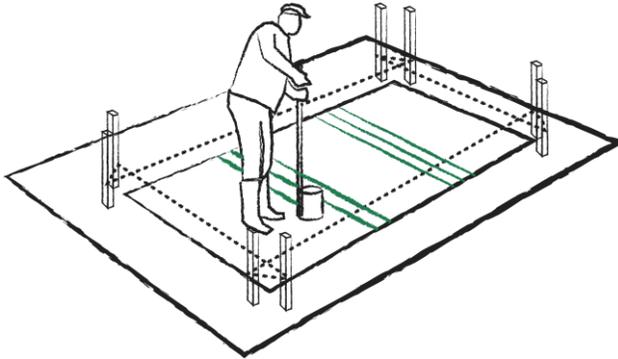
Construcción de cámaras de filtración. Fuente: Elaboración propia.
